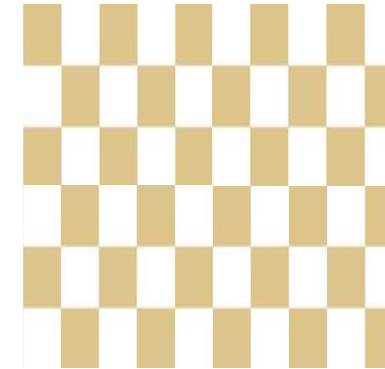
Pavimento hidráulico pasillo y lavandería
